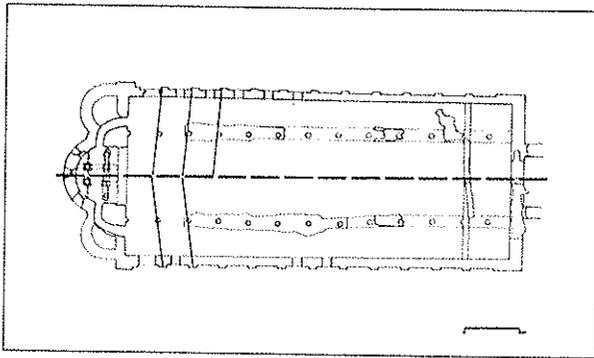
Brescia, S. Salvatore: verifica dell'applicazione del modulo dell'incolumnio.
